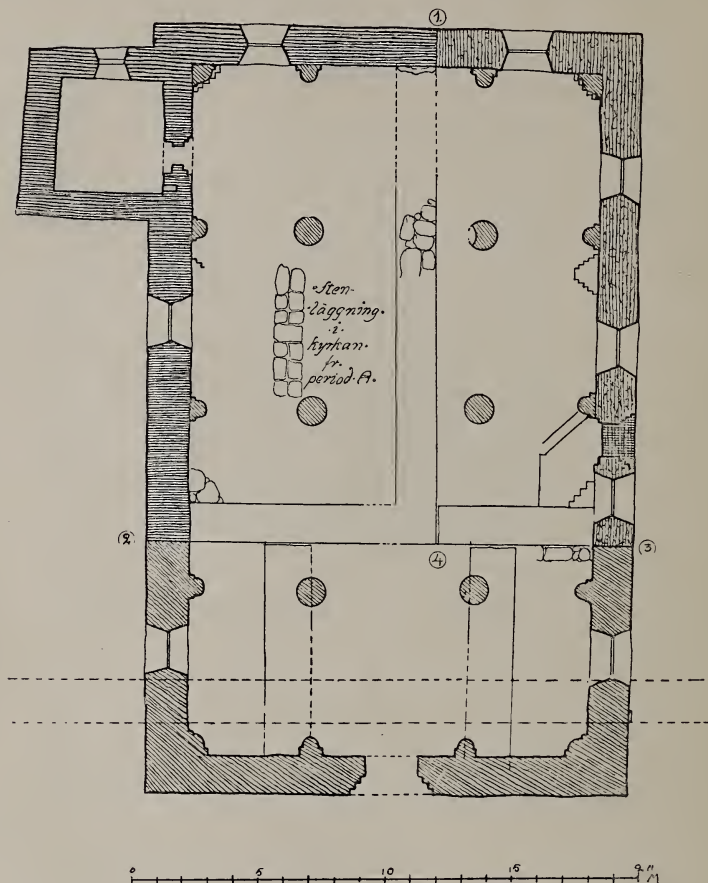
Danderyd. Plan av äldre grundmurar, blottade 1915.
